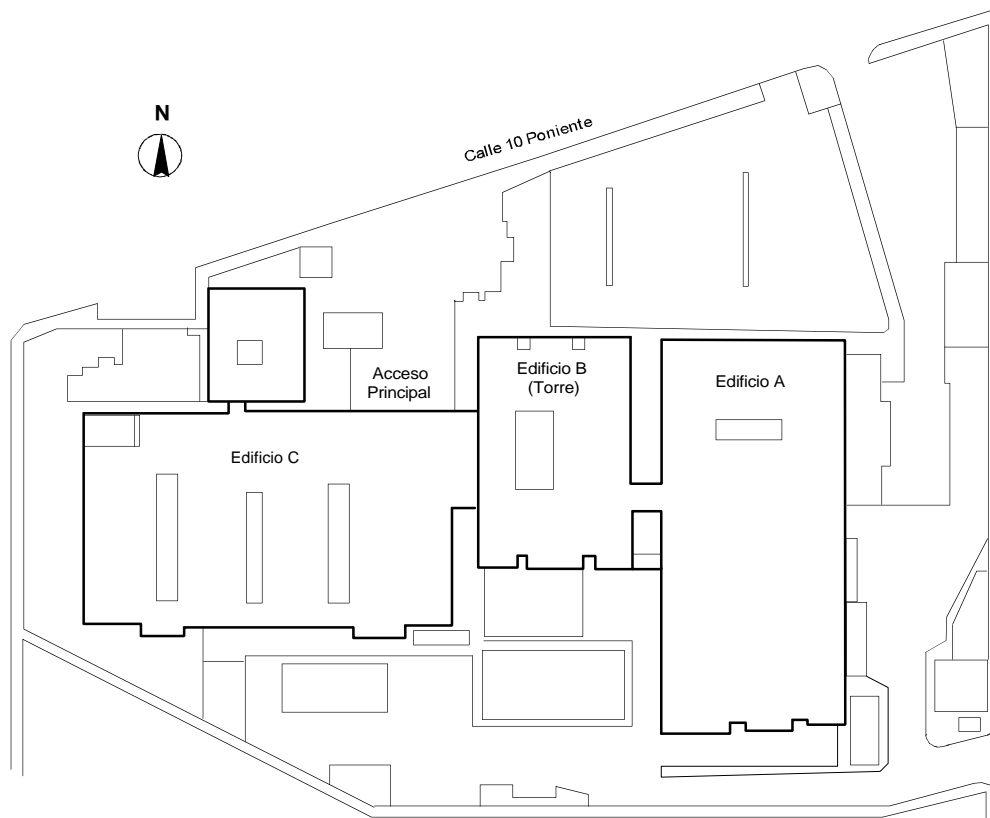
Planta de conjunto del Hospital San Alejandro
